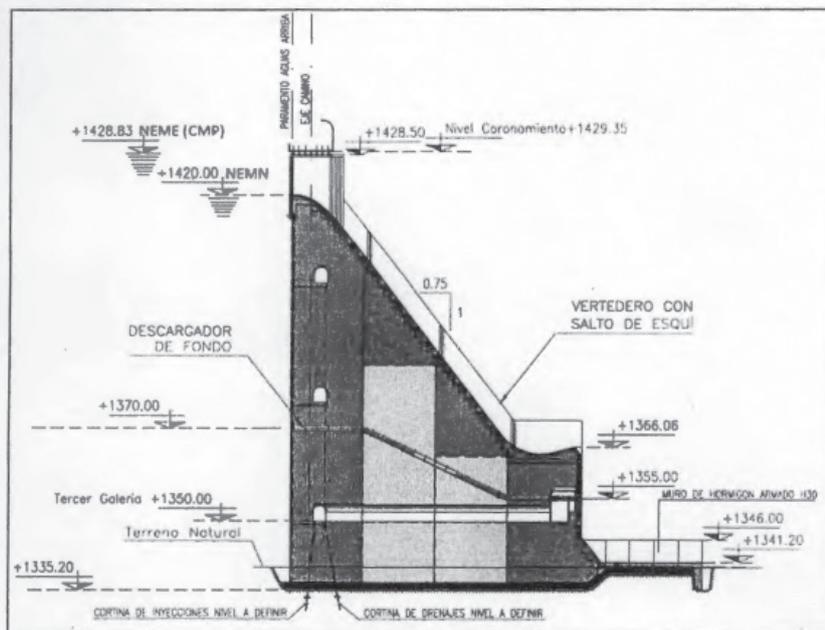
Perfil Tipo de la Presa de Hormigón
